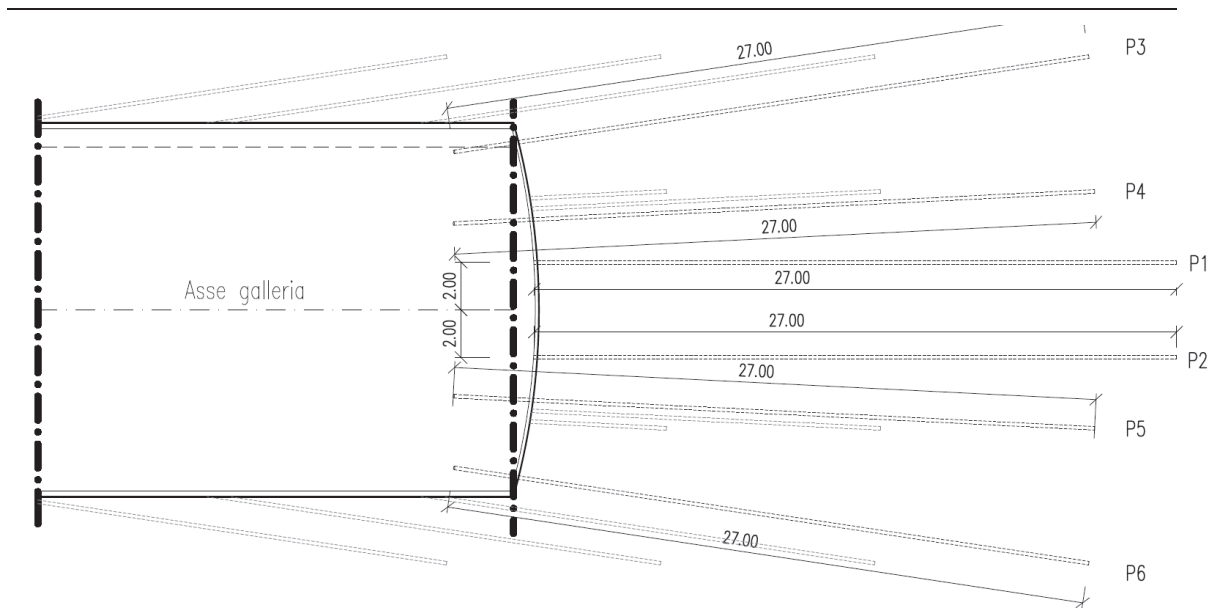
Perforazioni in avanzamento. Schema posizionamento fori – planimetria
